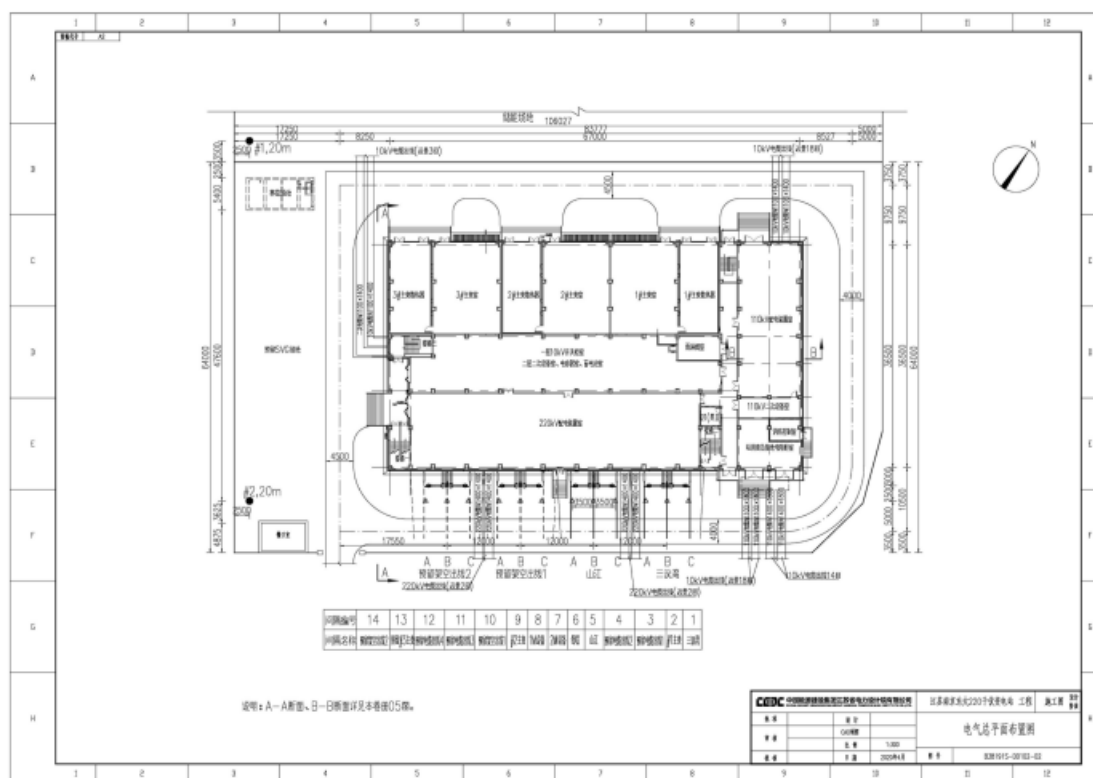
东大 220kV 变电站电气平面布置图
